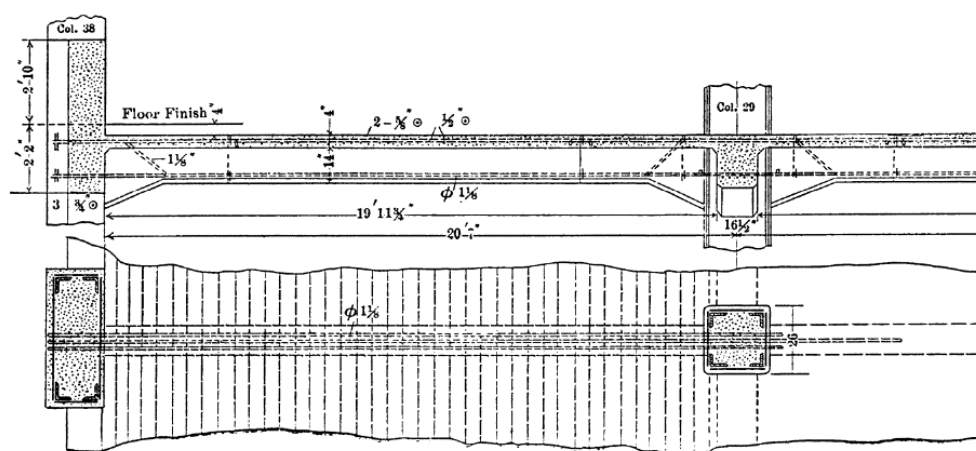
Edificio McGraw, sección de pilar y planta (Burr, 1908).
